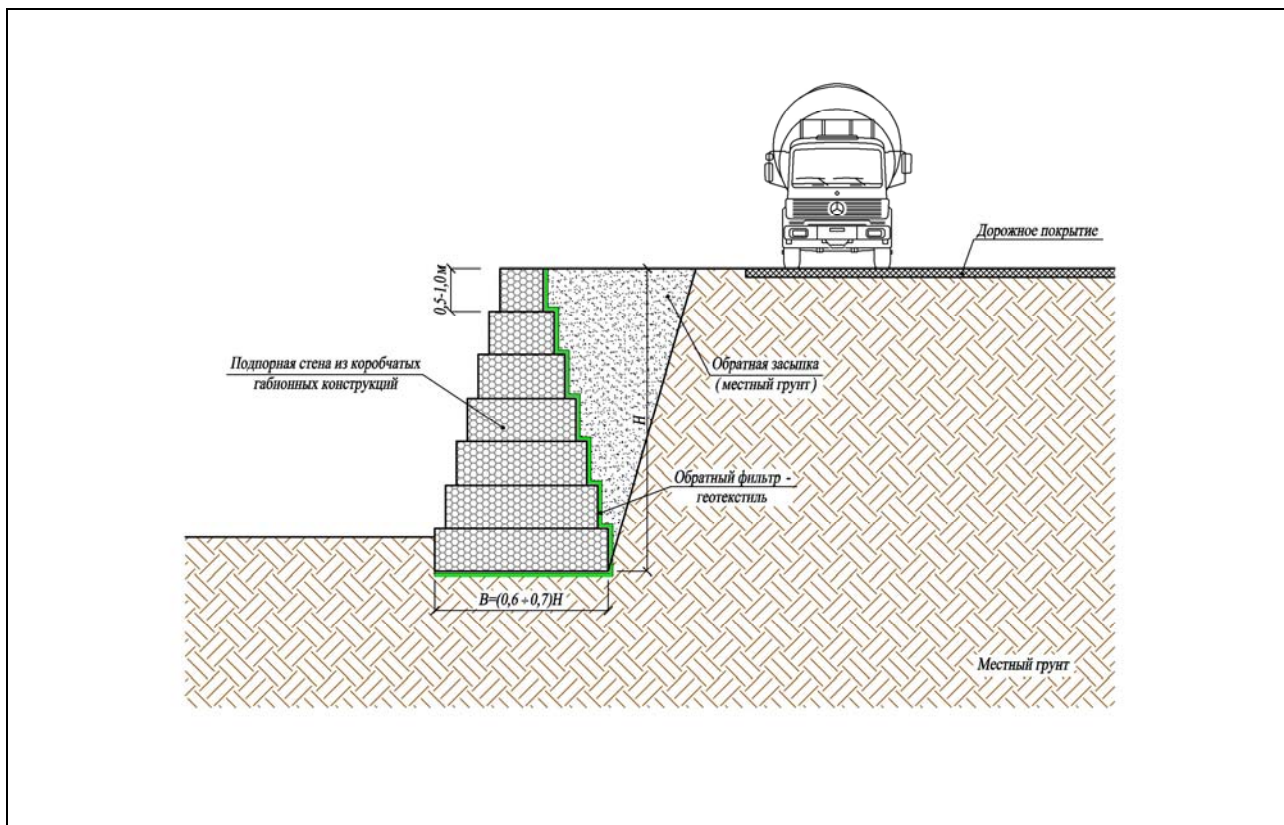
Схема подпорно-удерживающего сооружения из коробчатых габрионных конструкций
